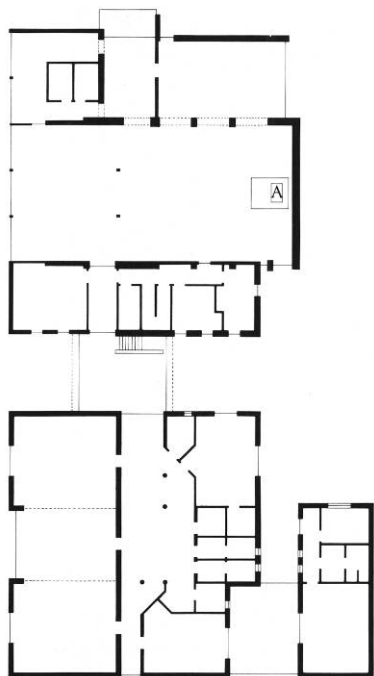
Plan 1:600. Efter Søren Jensen 1990, tegnet af MN 2000. - *Grundriss.
